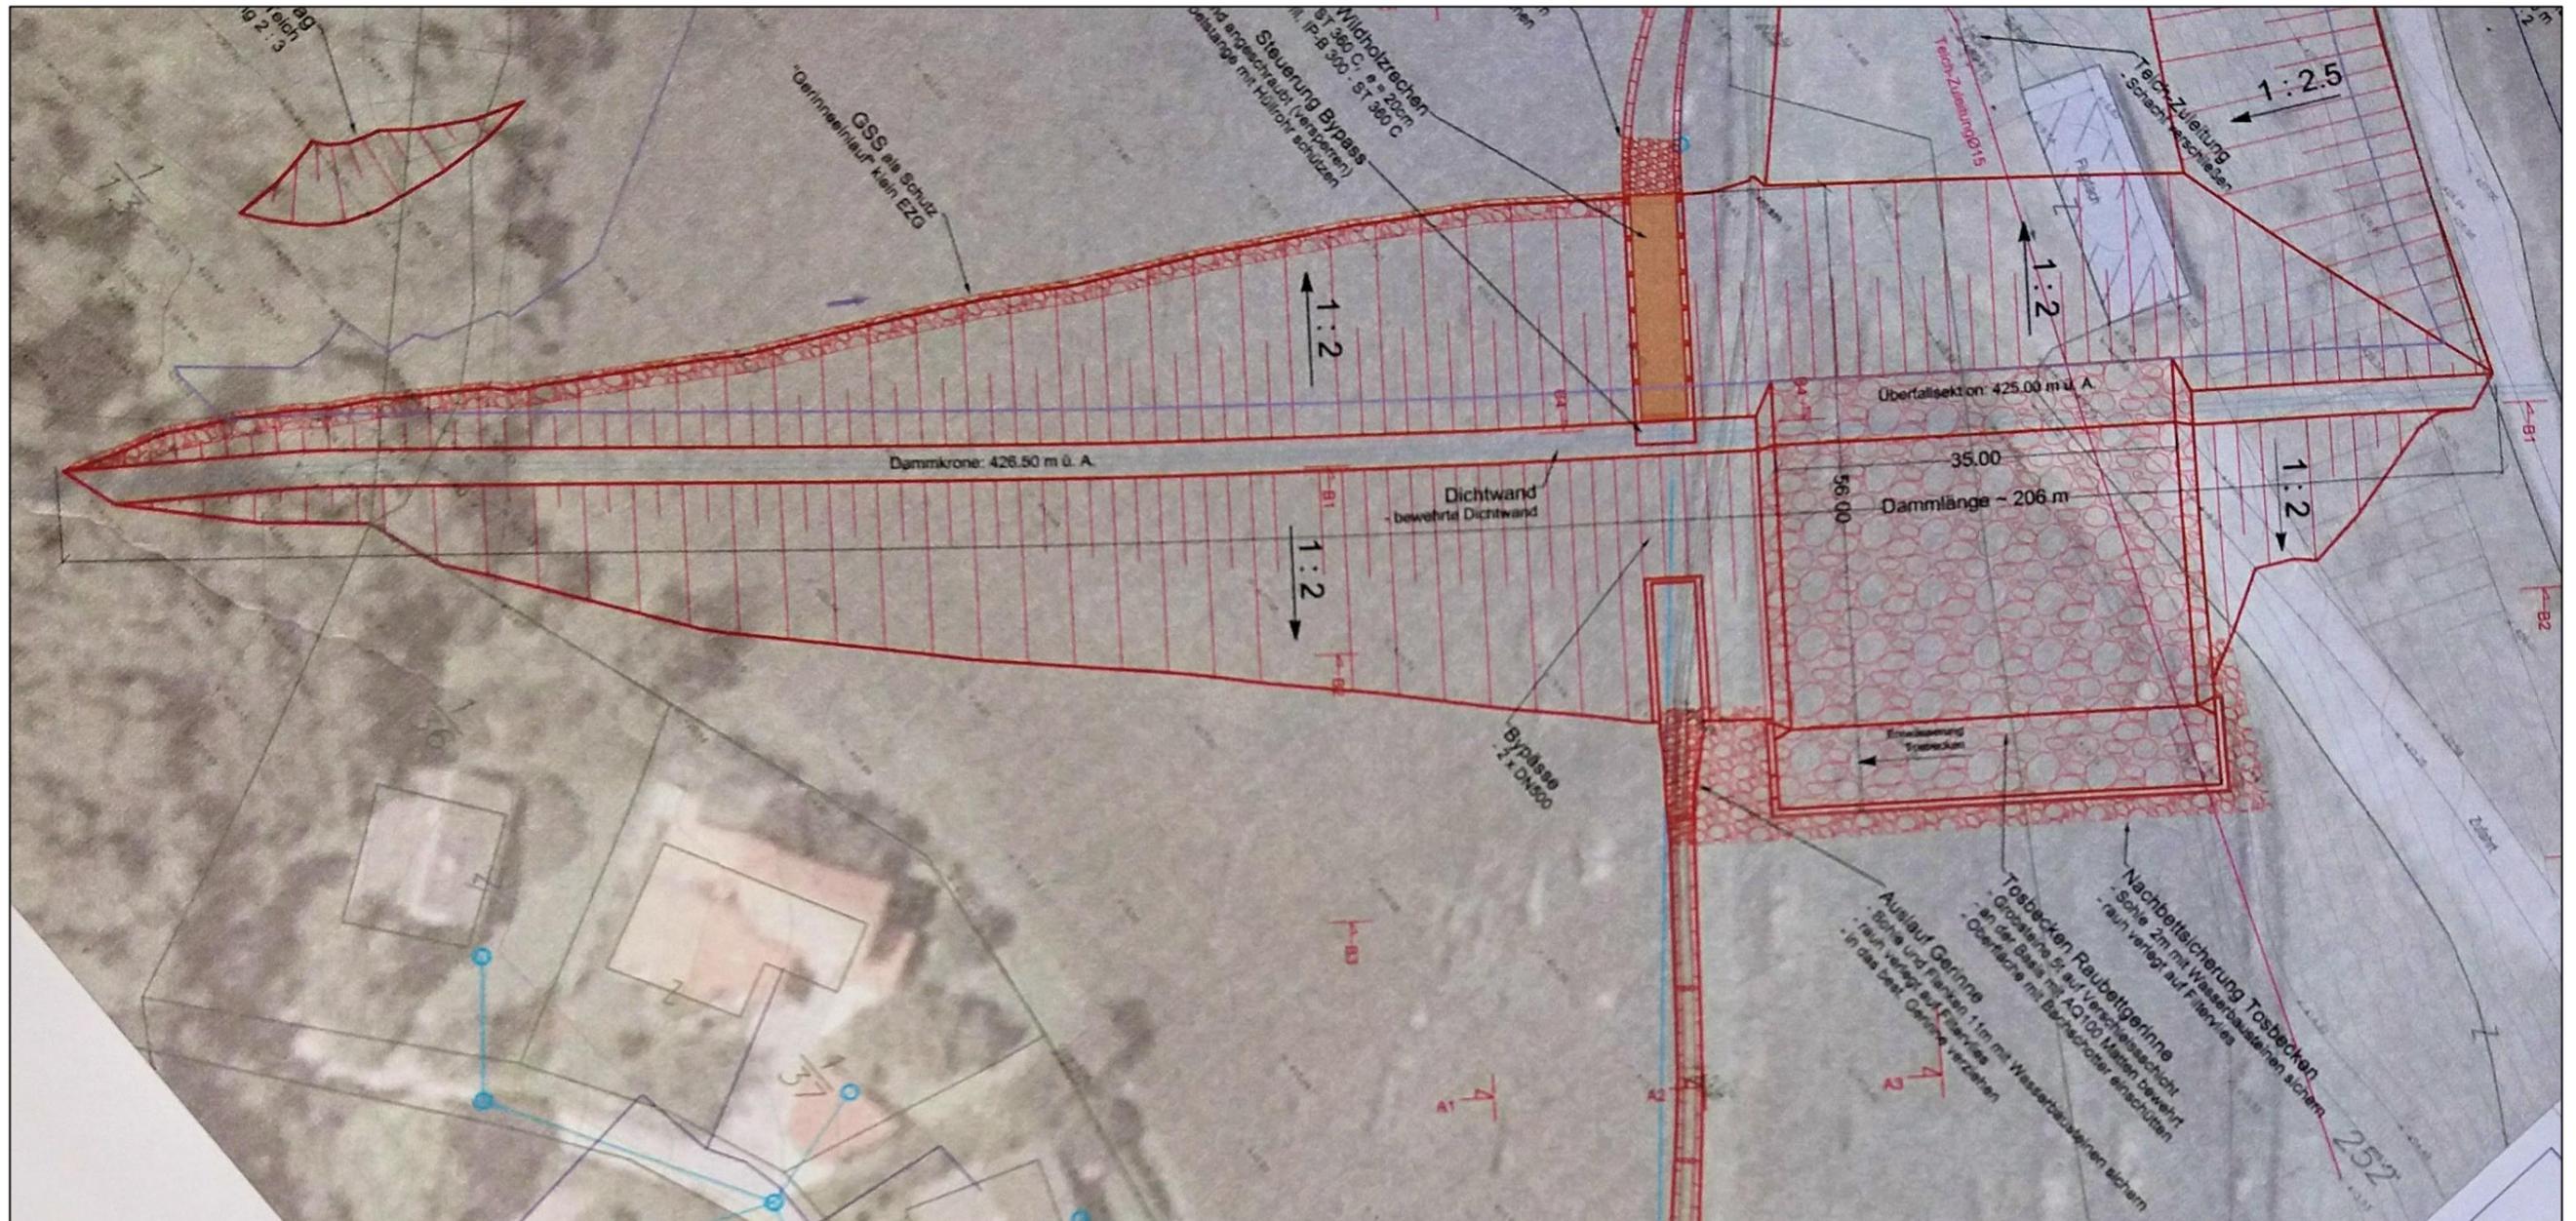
RHB Höllbach: Draufsicht (aus „Lageplan Damm Höllbach“) [Q8]
